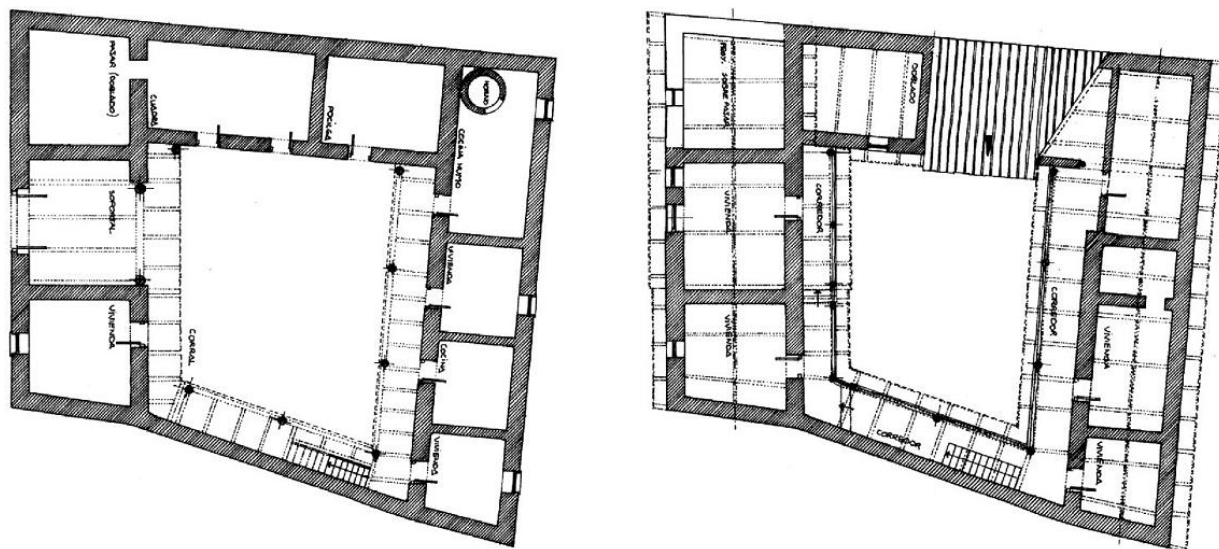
Plantas baja y alta de una casa de corral (ejemplo-1) [10]
